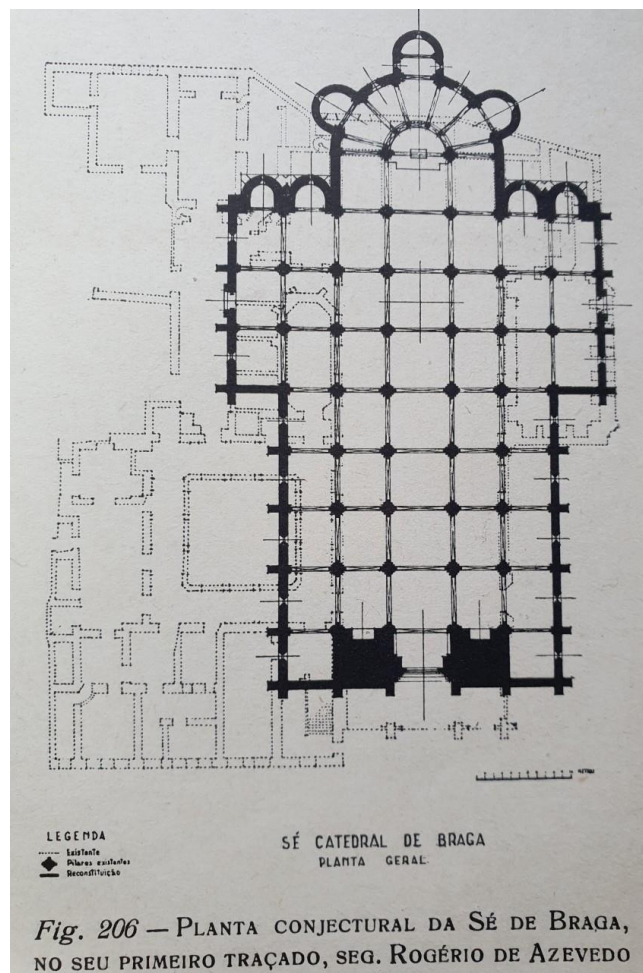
Posible planta de la primitiva catedral del Braga.
